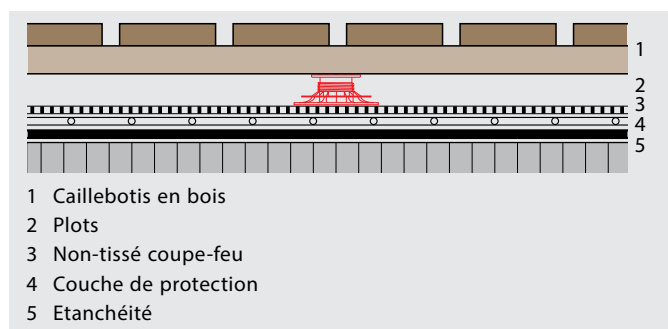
structure systémique d'un caillebotis en bois sur une construction à toit plat isolée thermiquement.
